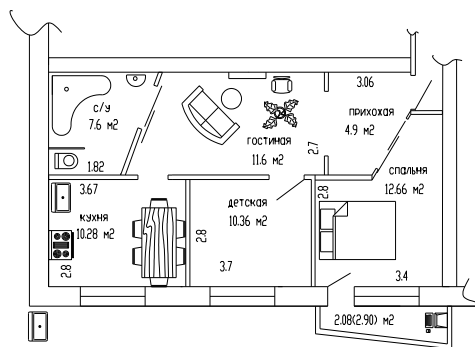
Вариант планировки трехкомнатной квартиры
